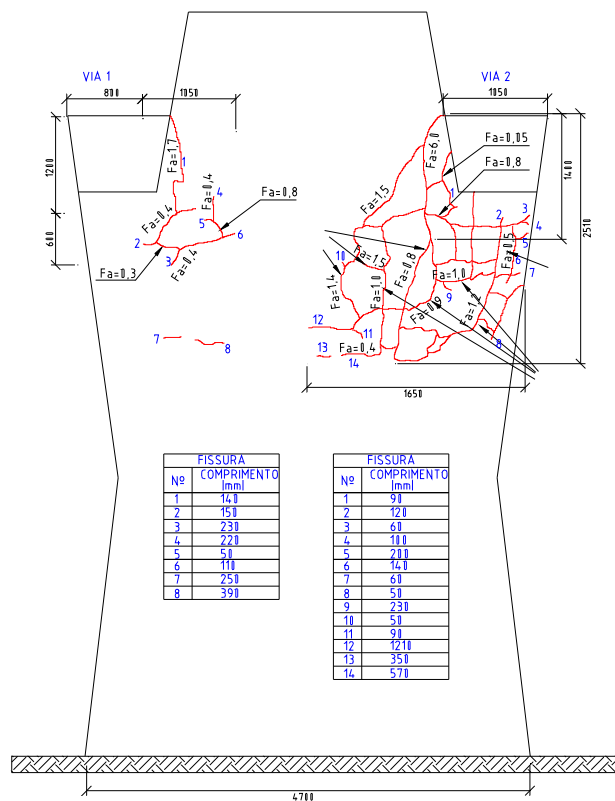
Croqui do Pilar - Vista Lateral, Longitudinal às Vias
